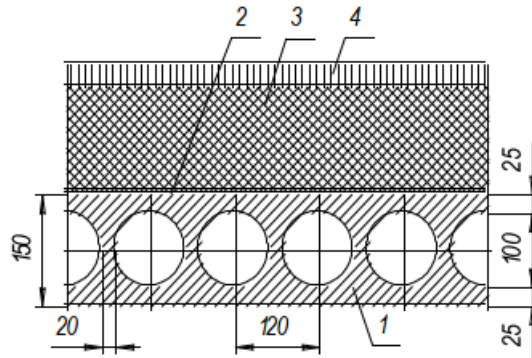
Схема до теплотехнічного розрахунку підвального перекриття: 1 – багатопустотна залізобетонна плита; 2 – пароізоляція; 3 – утеплювач; 4 – вирівнювальний шар.
